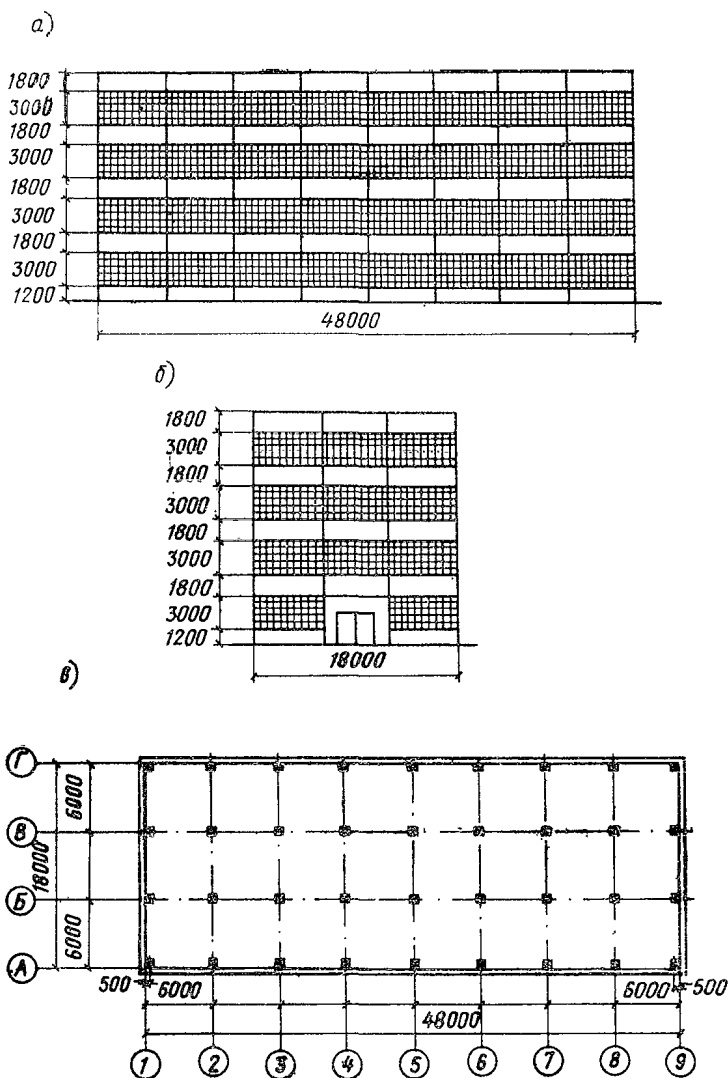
Схемы продольного (а) и торцового (б) фасадов здания и его план (в)
